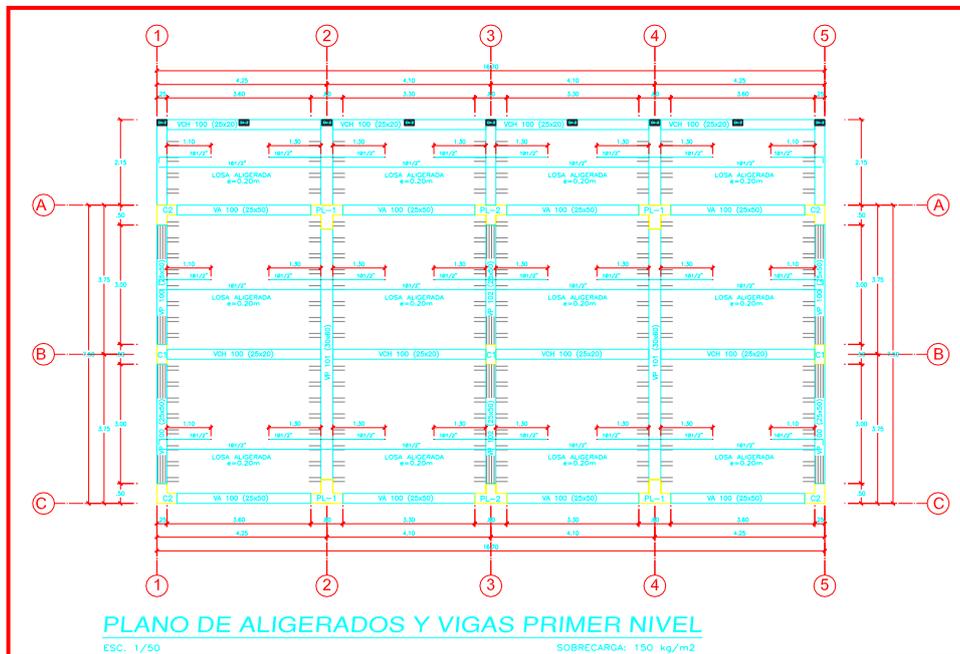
Plano de encofrado E-03 de la I.E. N° 586, El Dorado
